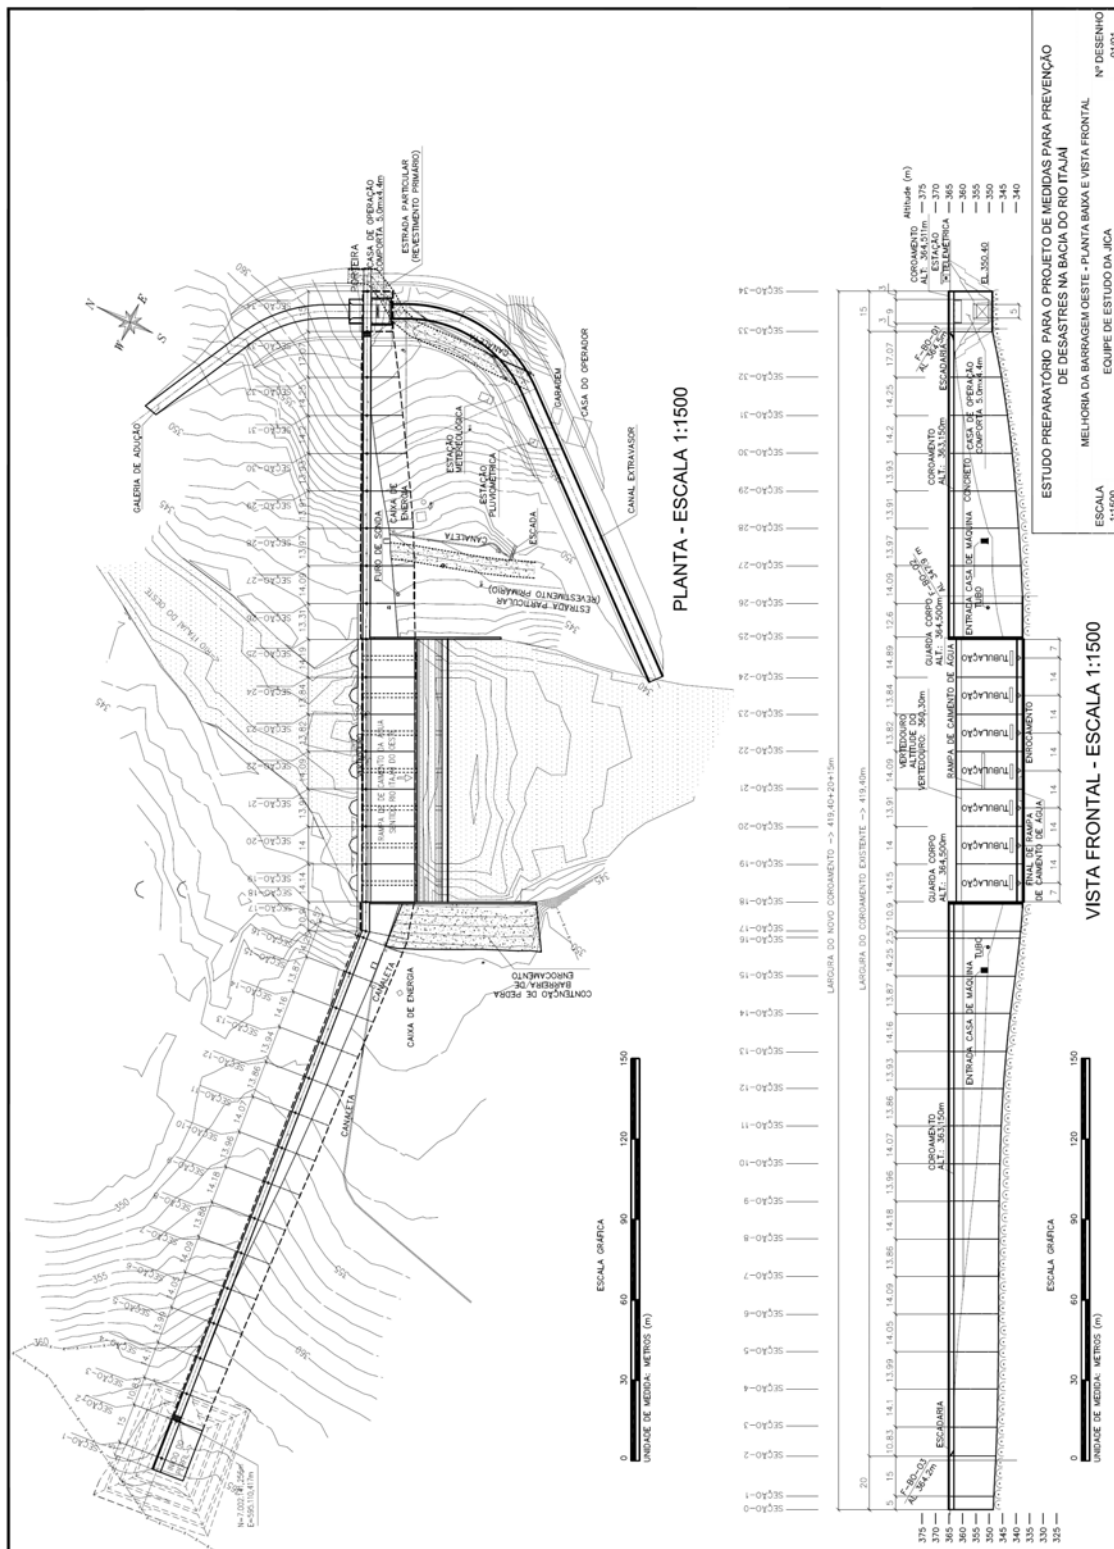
Desenho técnico da barragem Oeste após a sobre-elevação (1/2)
